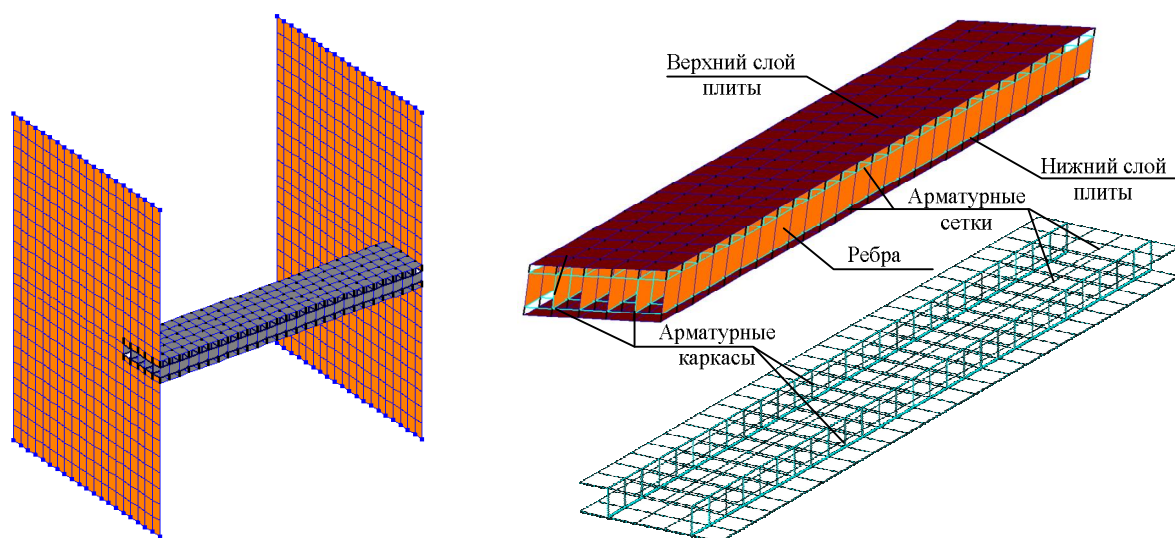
Конечно-элементная модель многопустотной плиты перекрытия / FE model of hollow-core floor slab
